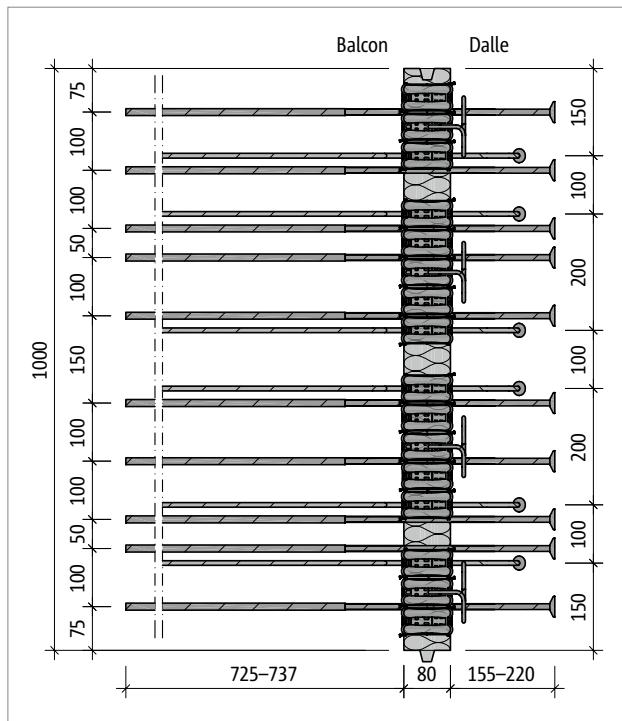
Schöck Isokorb® T type K-U-M4 : plan de base du produit
